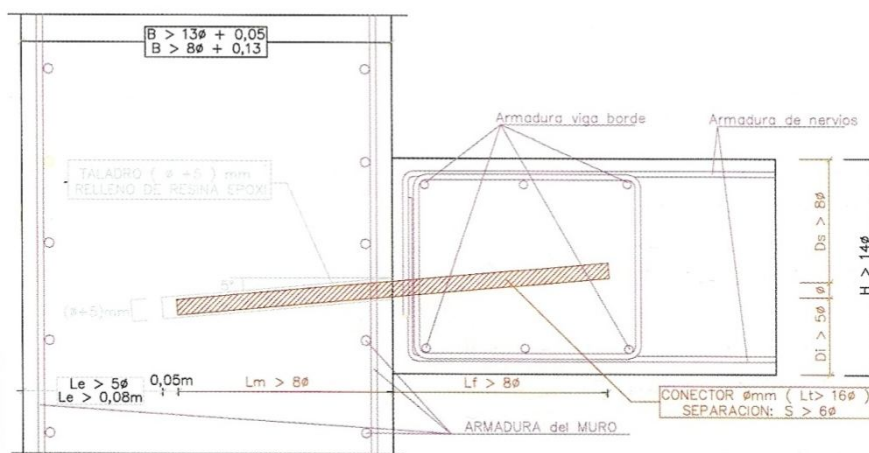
Ligação laje-muro com conector (Calavera, 1999)
